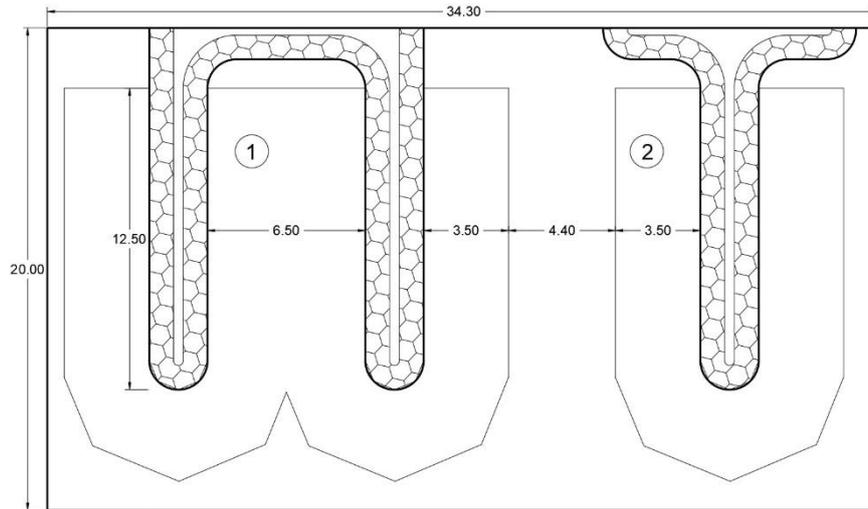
Vista en planta. Recolección de equipaje (internacional).
